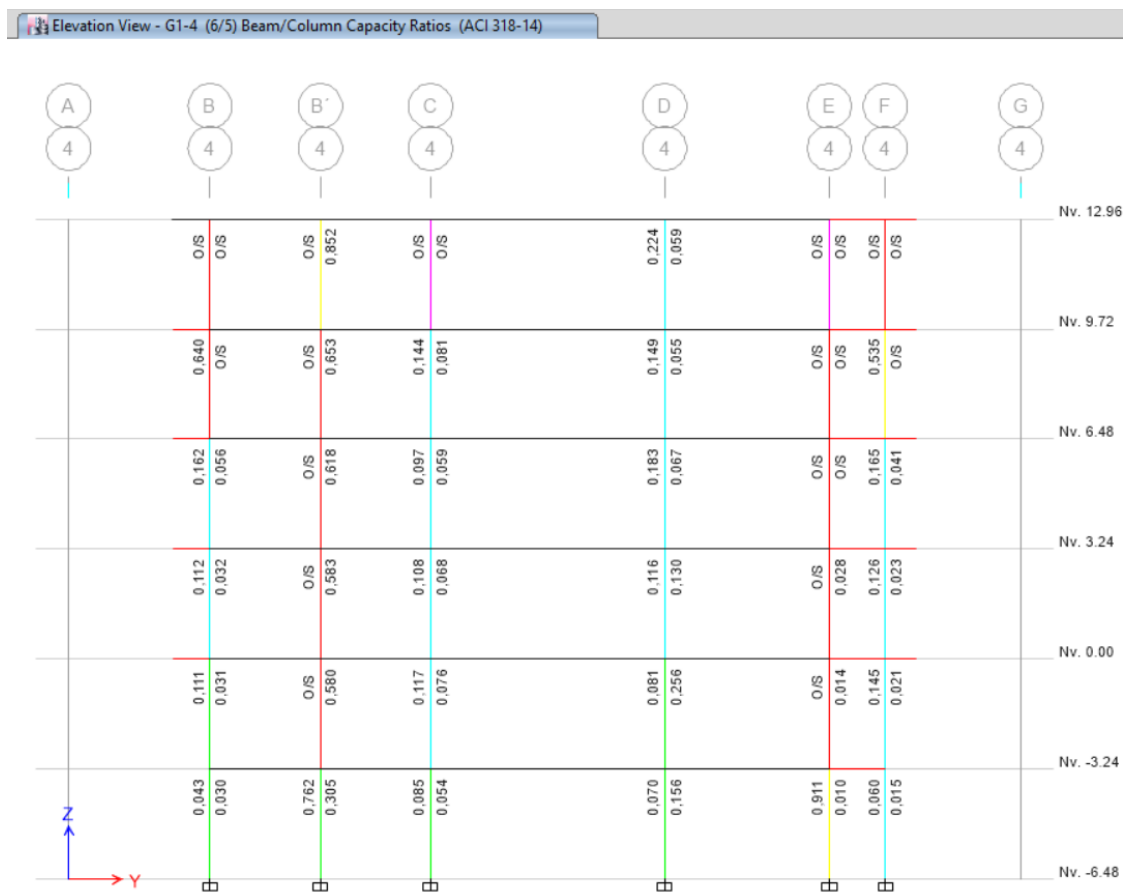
Vista en elevación de factor de capacidad unión viga-columnas, pórtico eje 3.
